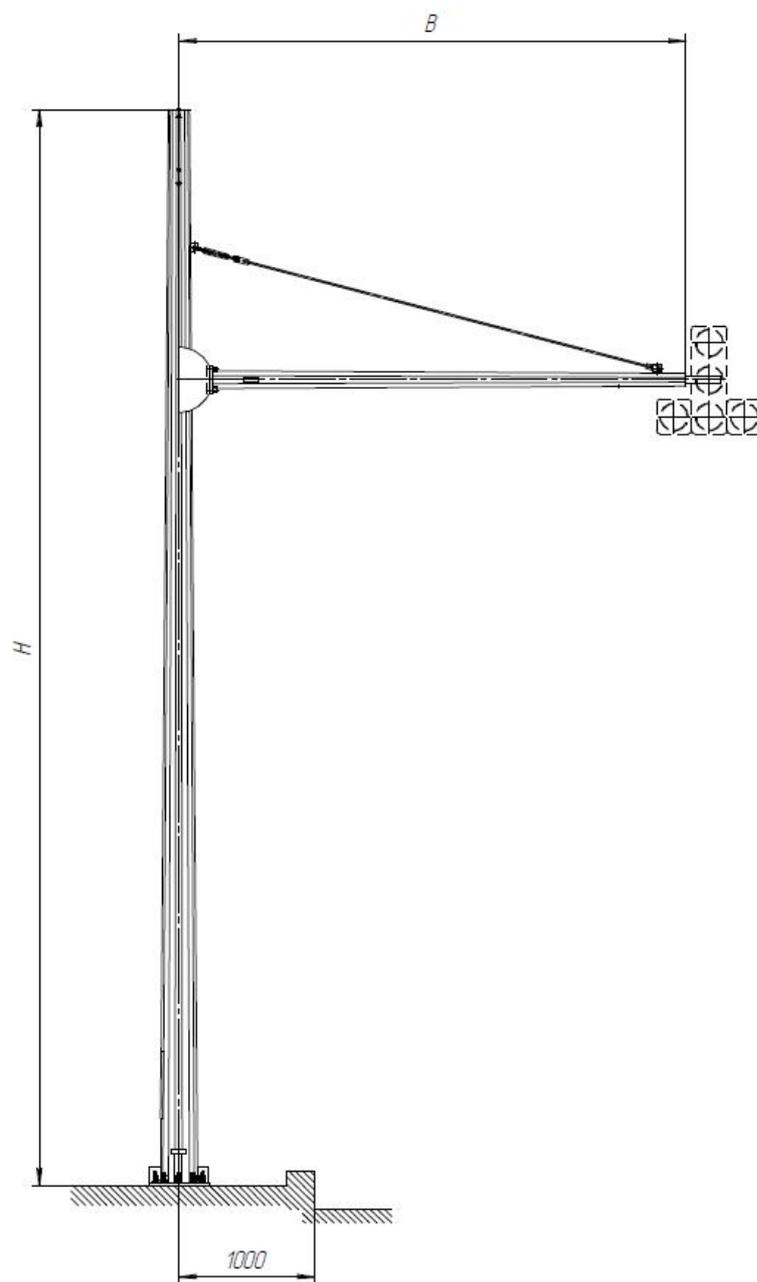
Общий вид светофорной опоры СВГ-Ф
